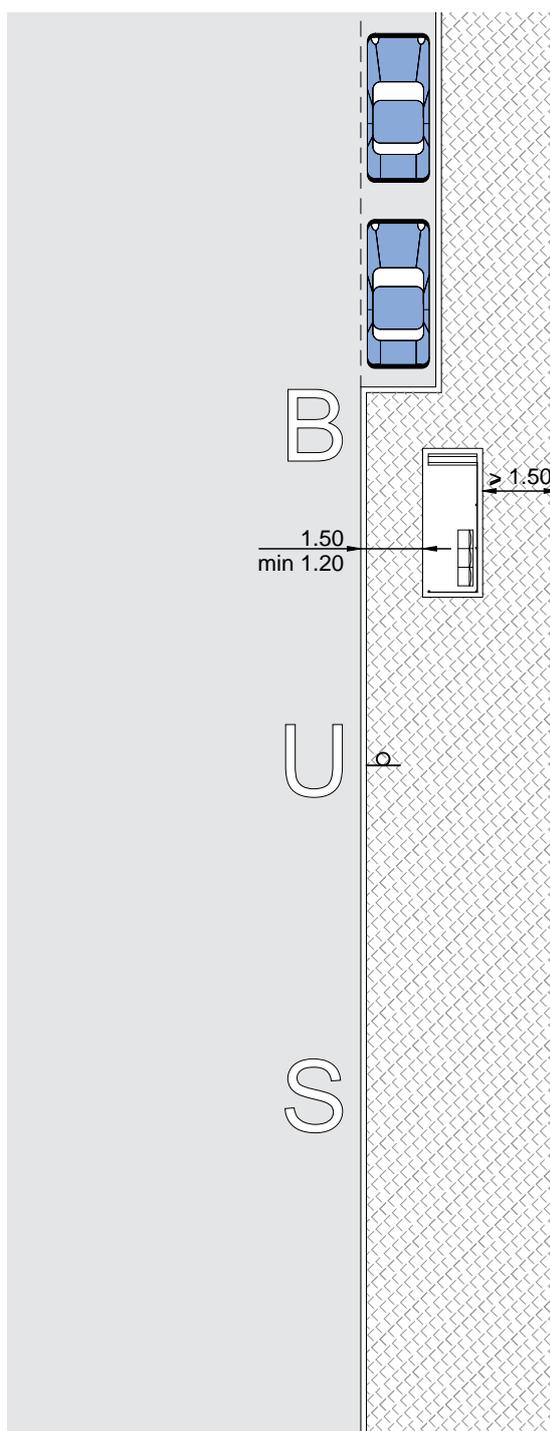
Bande cyclable suggérée à la hauteur d'un arrêt sur la chaussée
